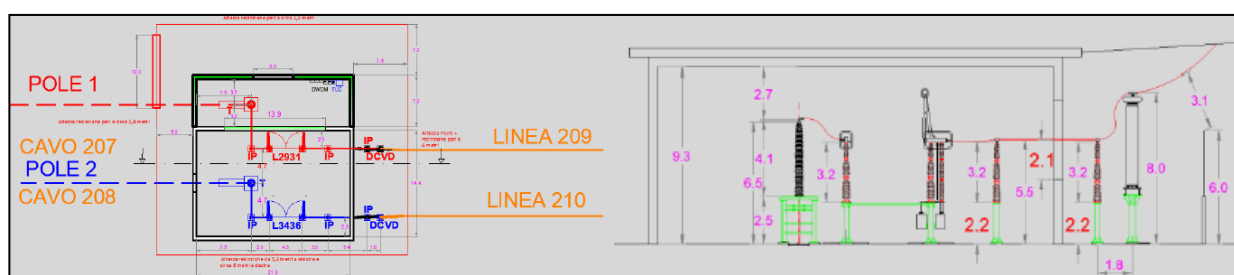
Schema collegamenti punto di transizione Salivoli in progetto
